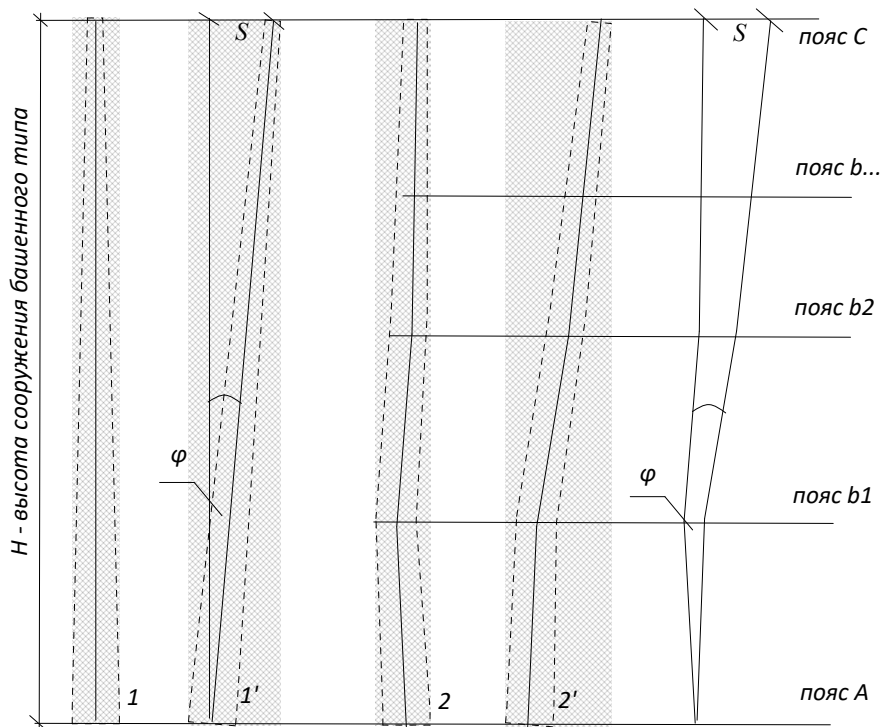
Принципиальная схема расчета крена высотного сооружения: 1-1' простейшая схема без поясов, 2.2' схема с расчета по поясам
